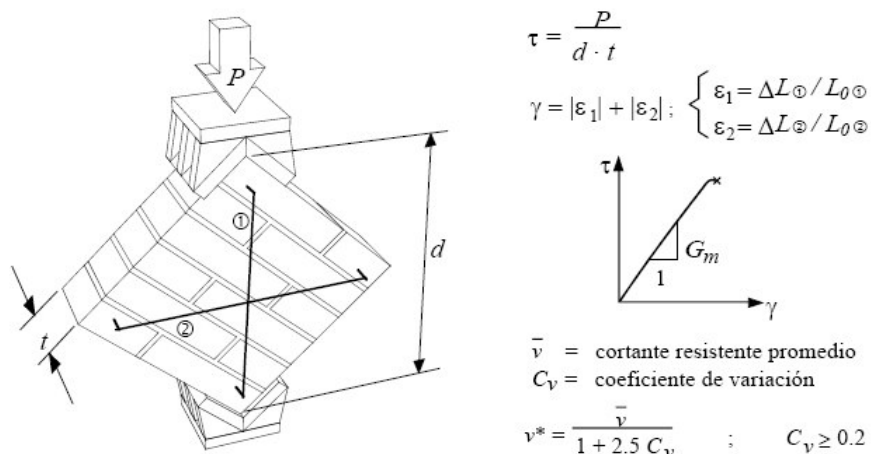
Ensayo de Pilas de Muretes de Mampostería a Compresión Diagonal.
